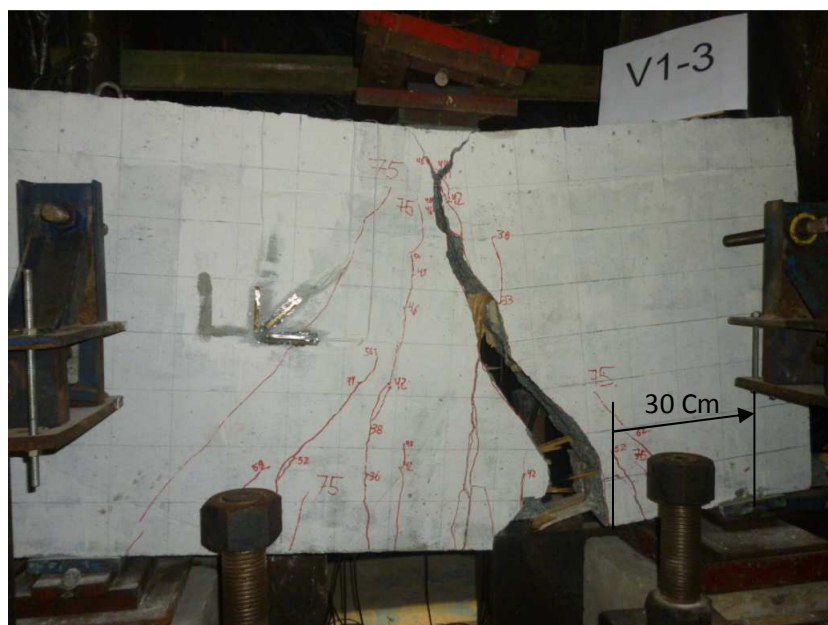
Configuração de fissuras - Viga V1-3.
